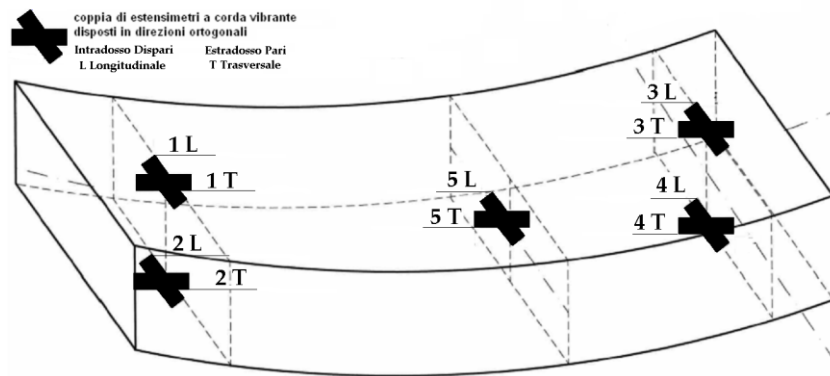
Schema della disposizione delle 5 coppie estensimetriche in un concio tipo.
